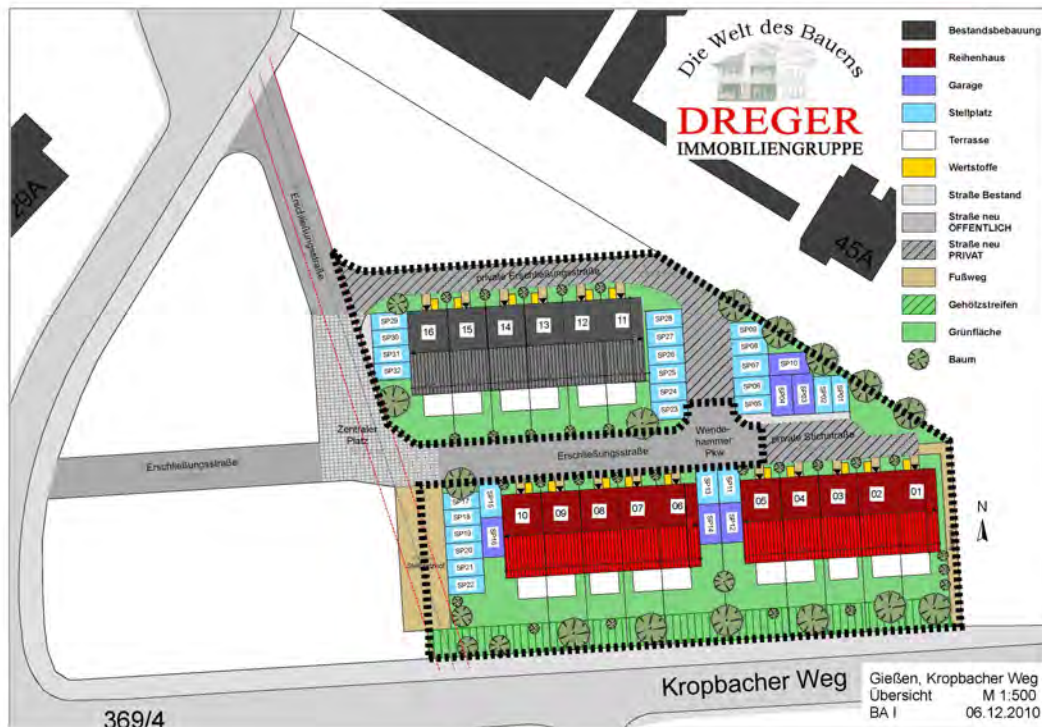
Vorgesehener 1. Bauabschnitt mit schwarz gestrichelter Abgrenzung des Baugrundstückes (nach WEG)
